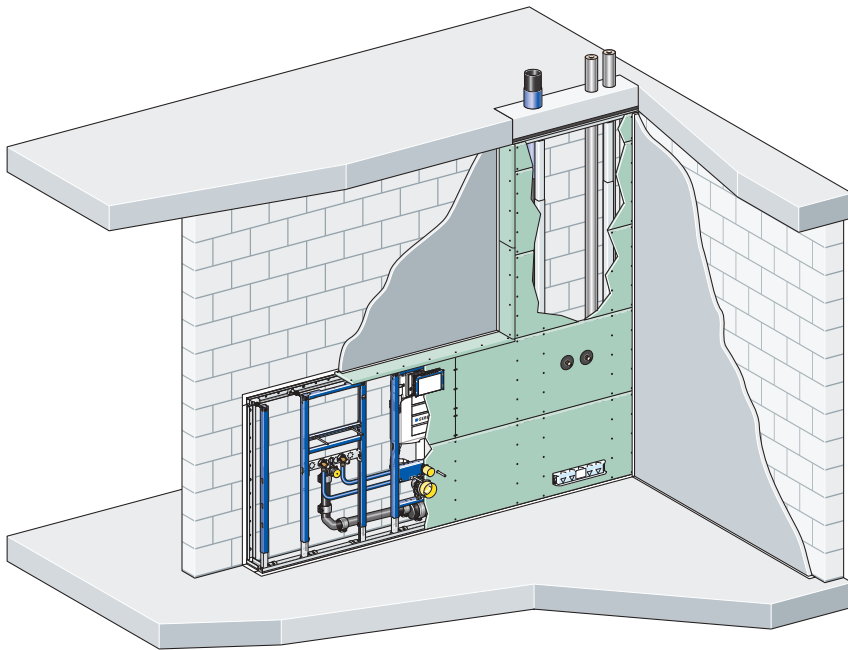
Sistema Geberit Duofix con installazione applicata davanti alla parete
